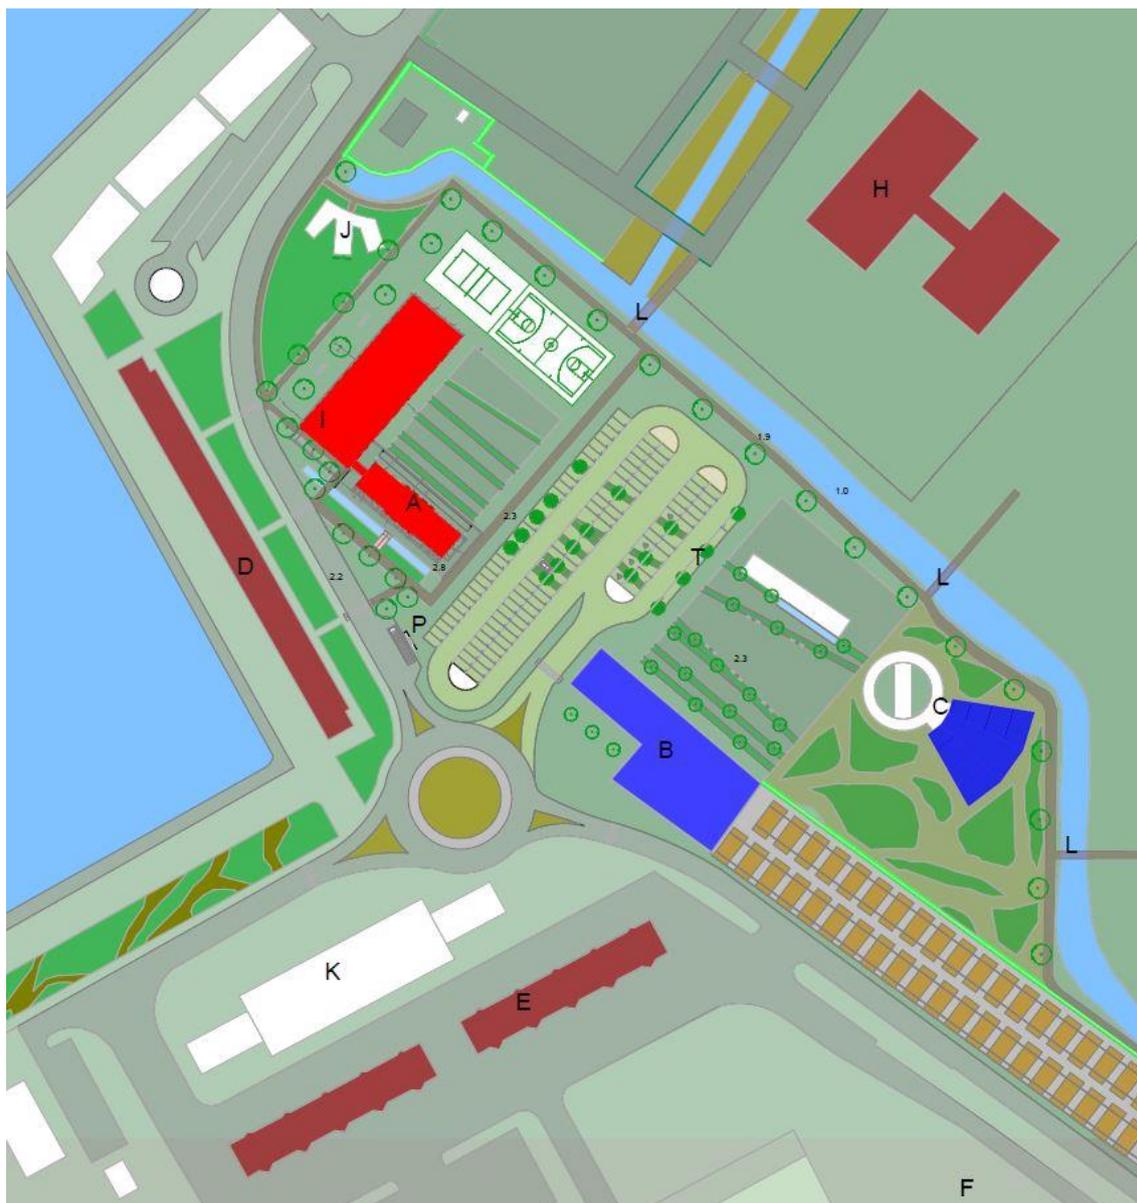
\_ Planta de implantação da proposta (legenda na página 58).
